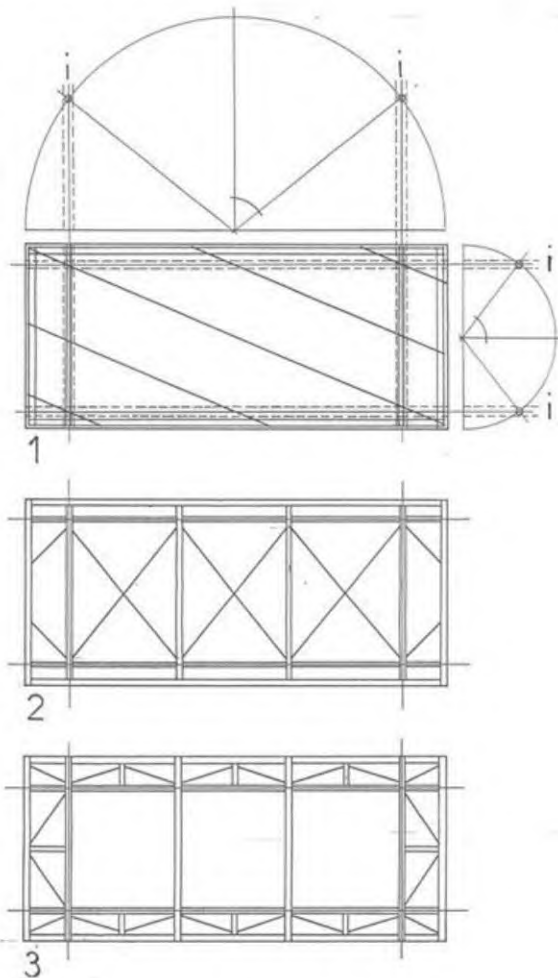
Exemples de structures de planchers courants en béton armé, acier et bois.
